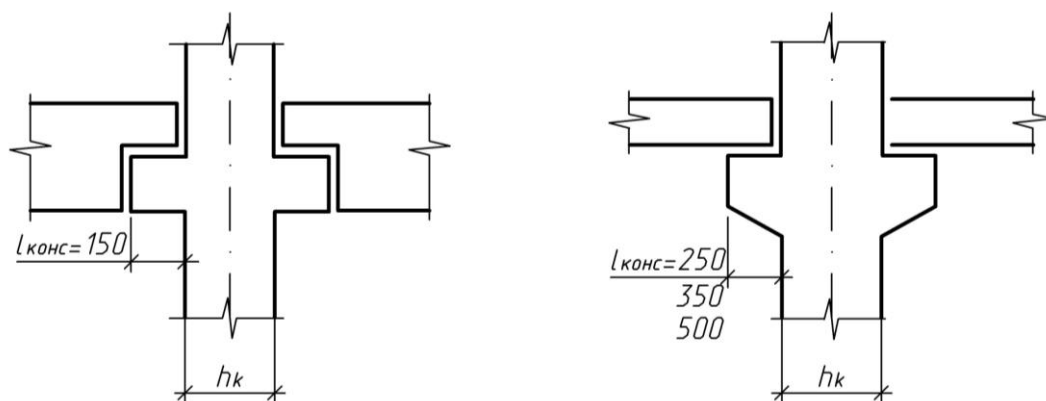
Конструкции консолей железобетонных колонн
